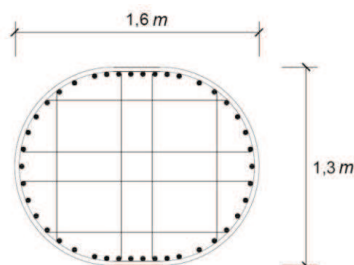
Seção transversal do pilar do viaduto V22.
